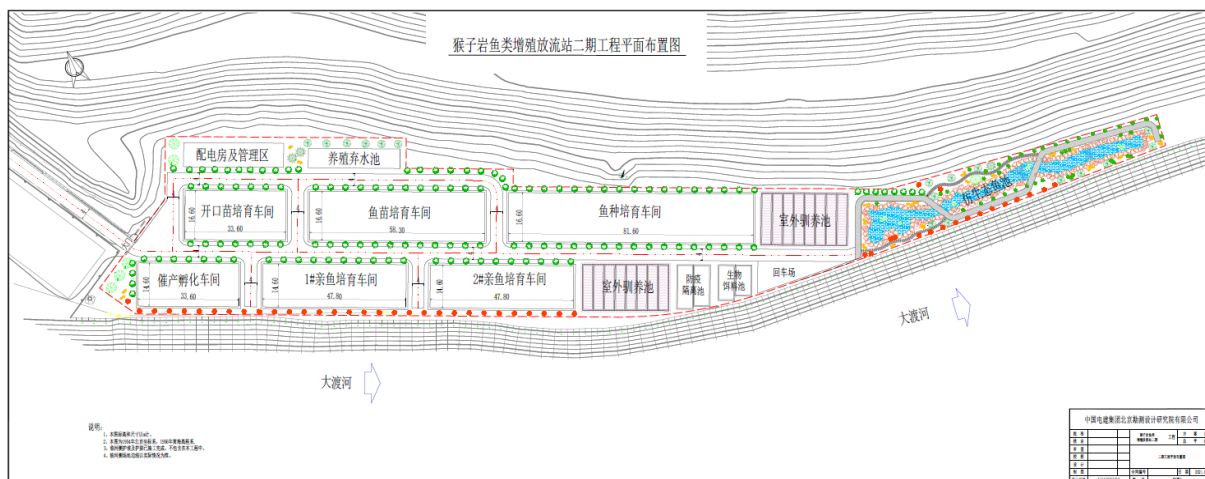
猴子岩鱼类增殖站二期工程总平面布置图
